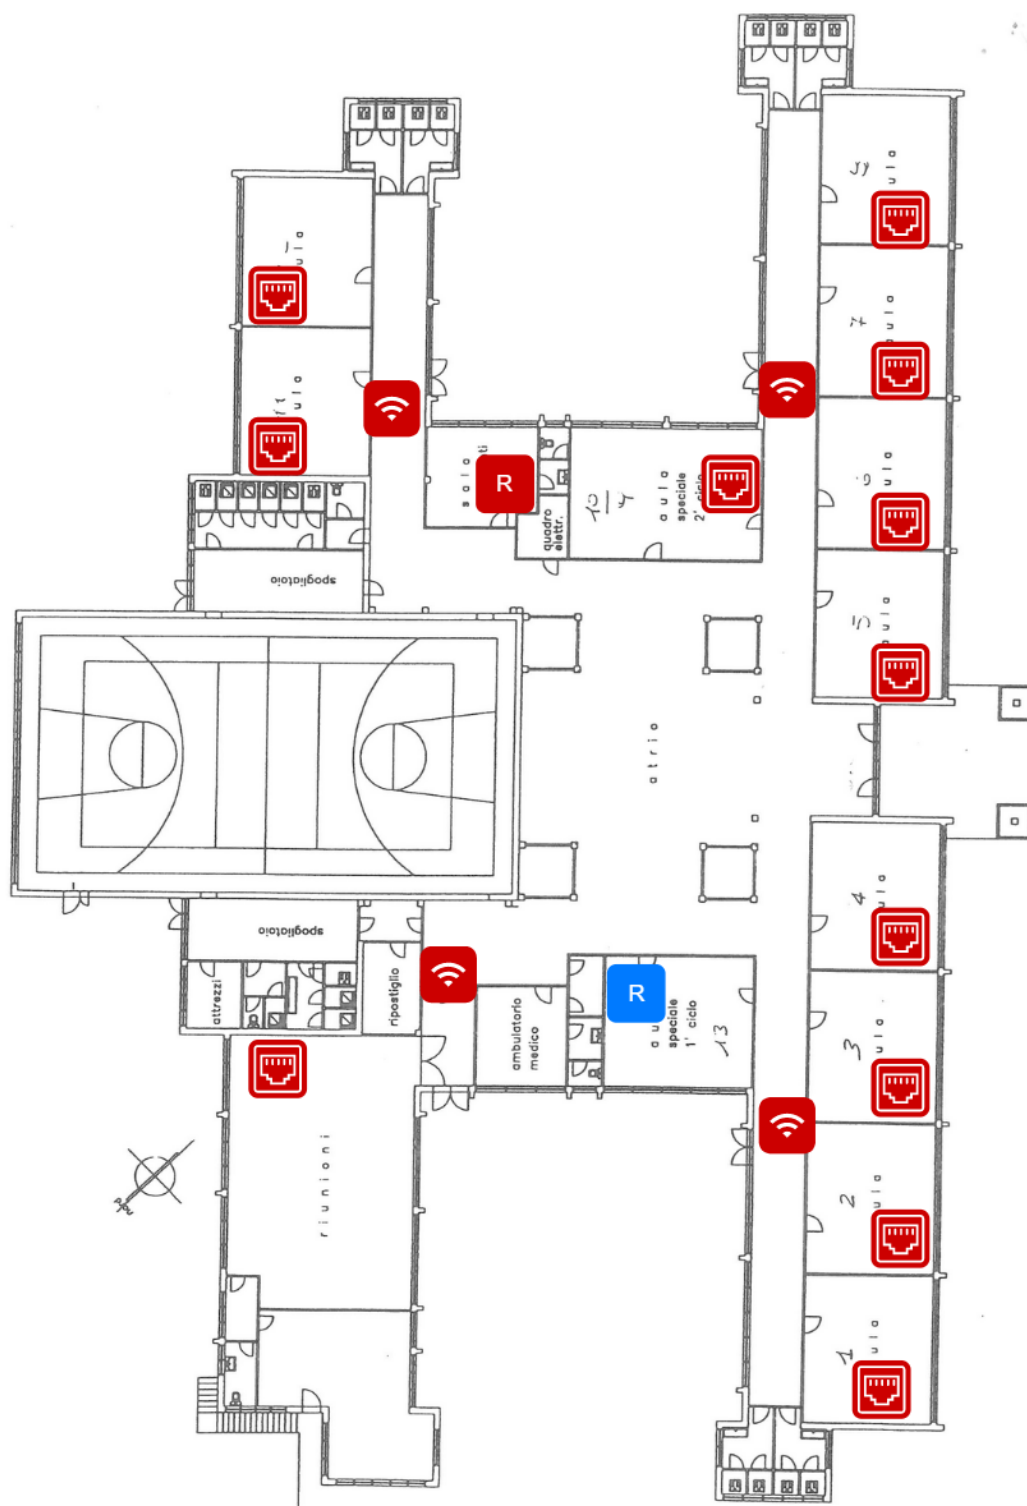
Planimetria Scuola Primaria di Beregazzo - Piano terra
